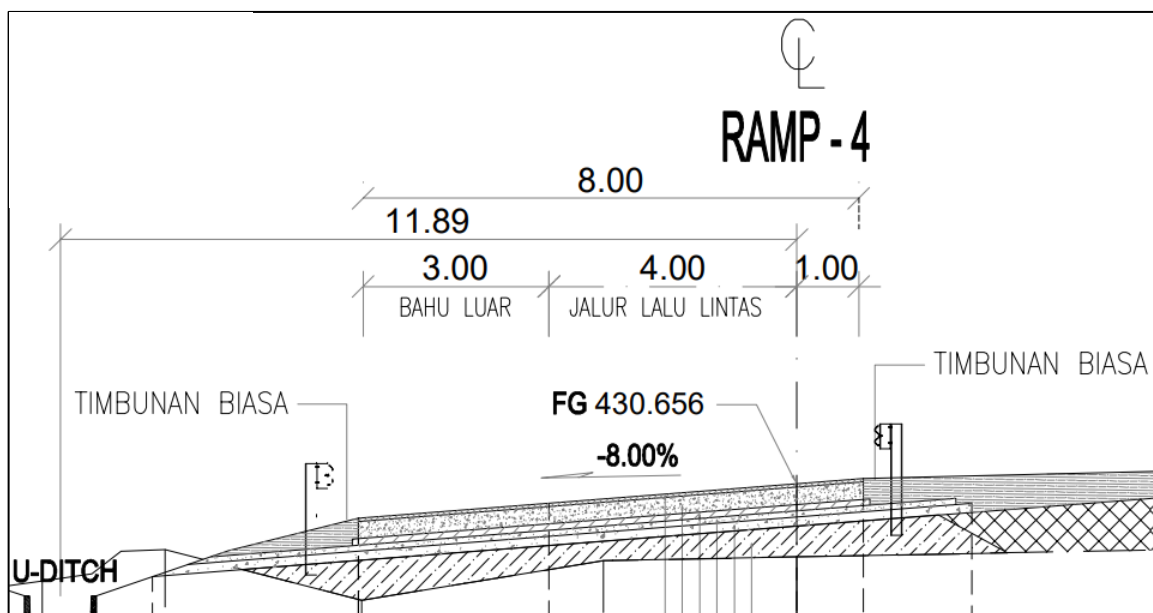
Cross Section Ramp 4 - Interchange Ciawi
